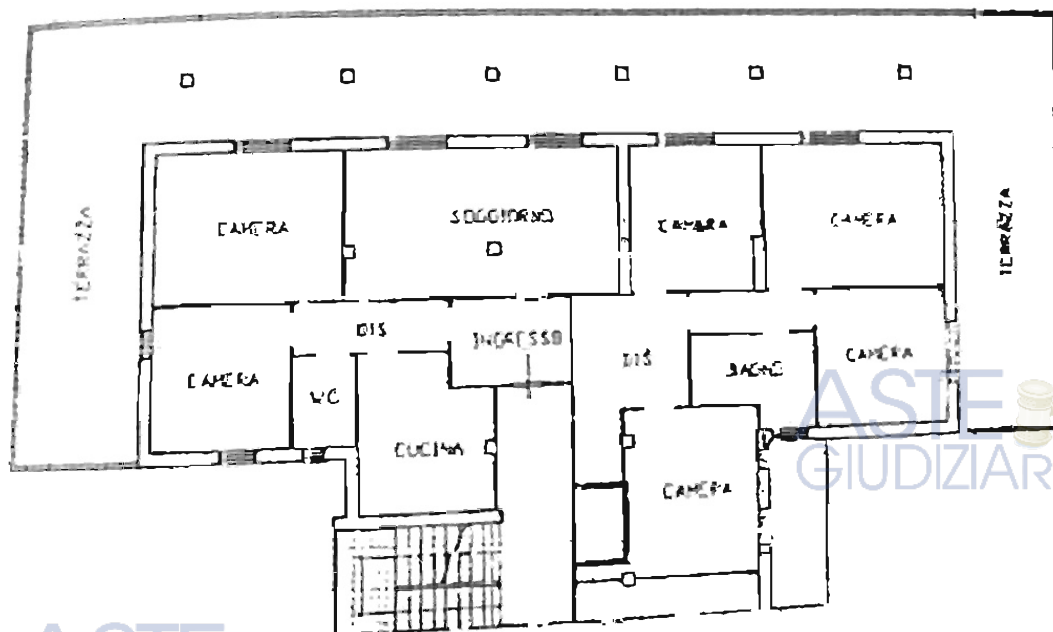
Planimetria catastale rogito - Pianta piano settimo
